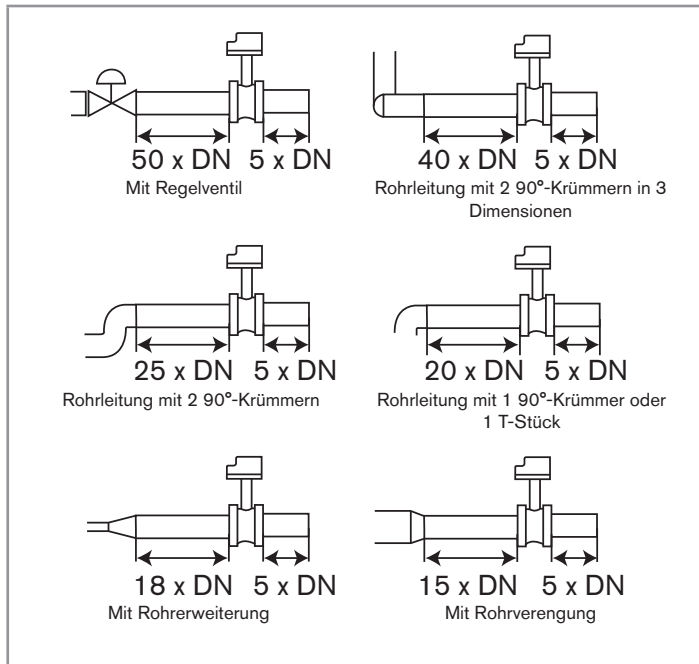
Mindest-Ein- und -Auslaufstrecken je nach Aufbau der Rohrleitungen.
